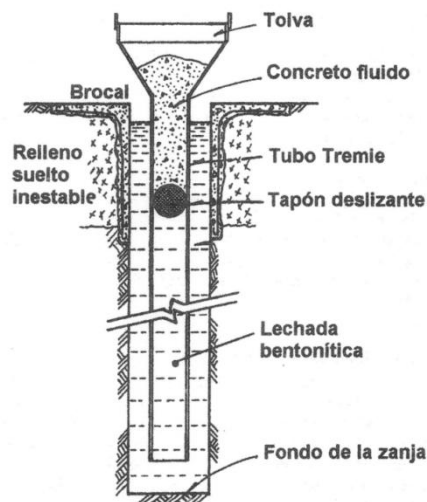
Esquema de un tubo Tremie para el colado de concreto bajo lechada bentonítica (Enrique Tamez González).
